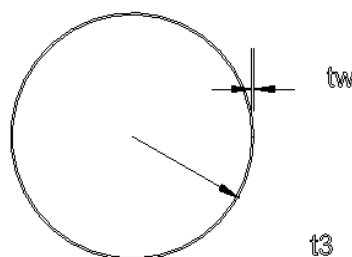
Ilustración de la sección pipe (tubular) para el modelamiento de cordones, montantes y diagonales.
